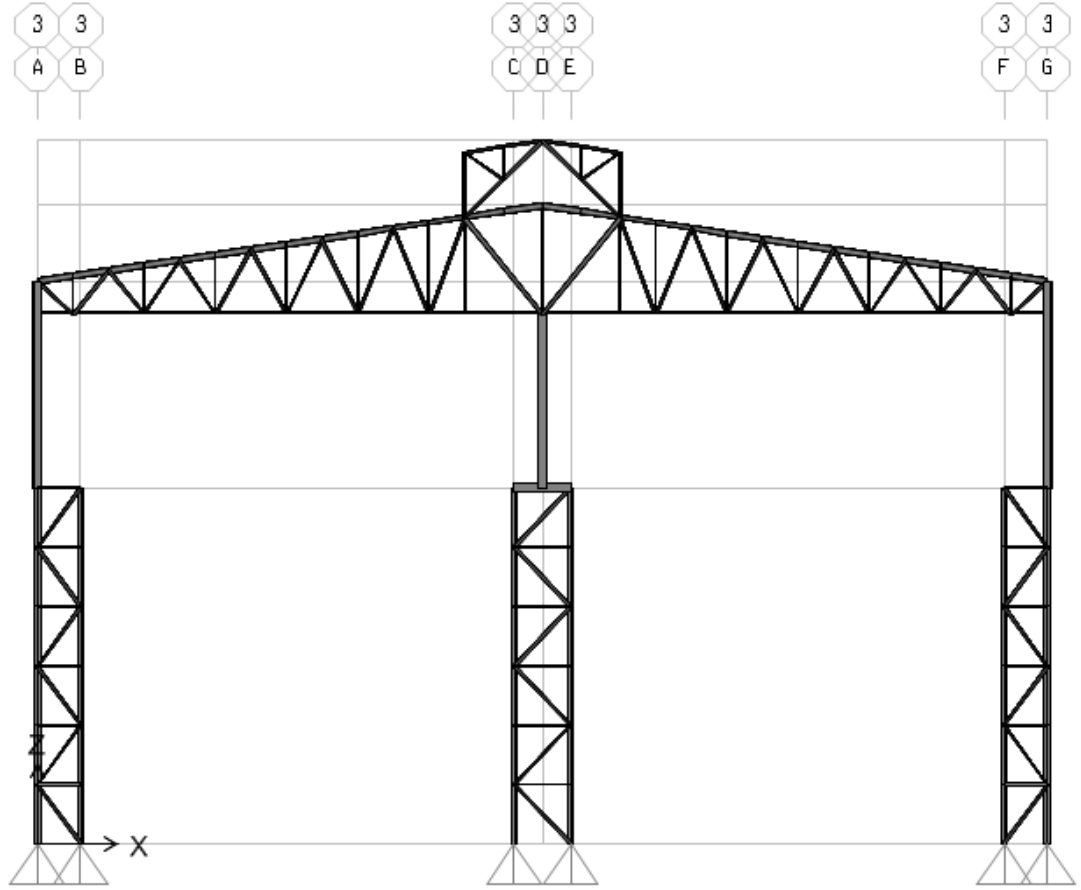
Yapı Sisteminin Çatı Plan Görünüşü.
